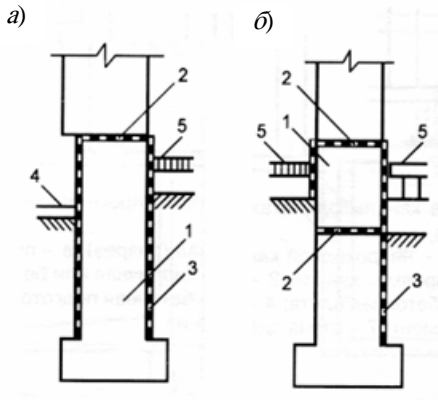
Гидроизоляция фундаментов бесподвальных зданий с полами по грунту:
